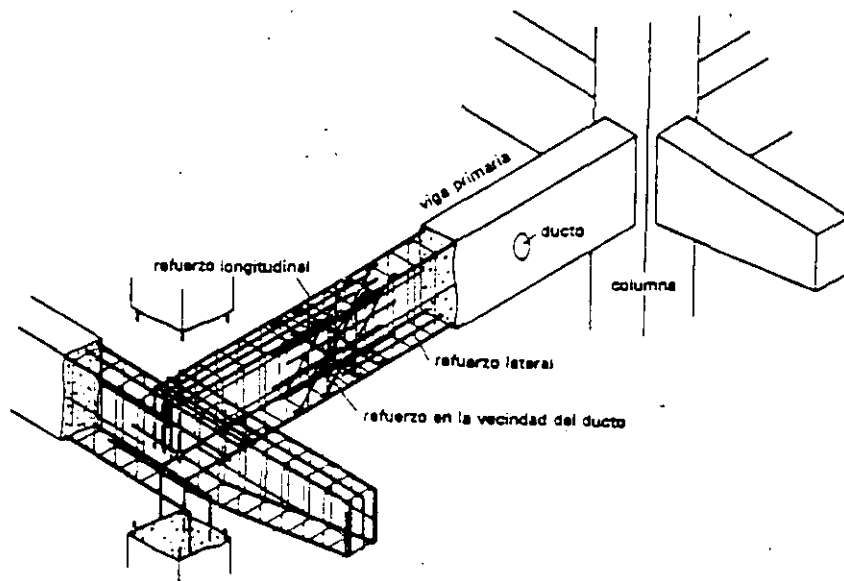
Detalle de refuerzo para ductos en el alma de viga
